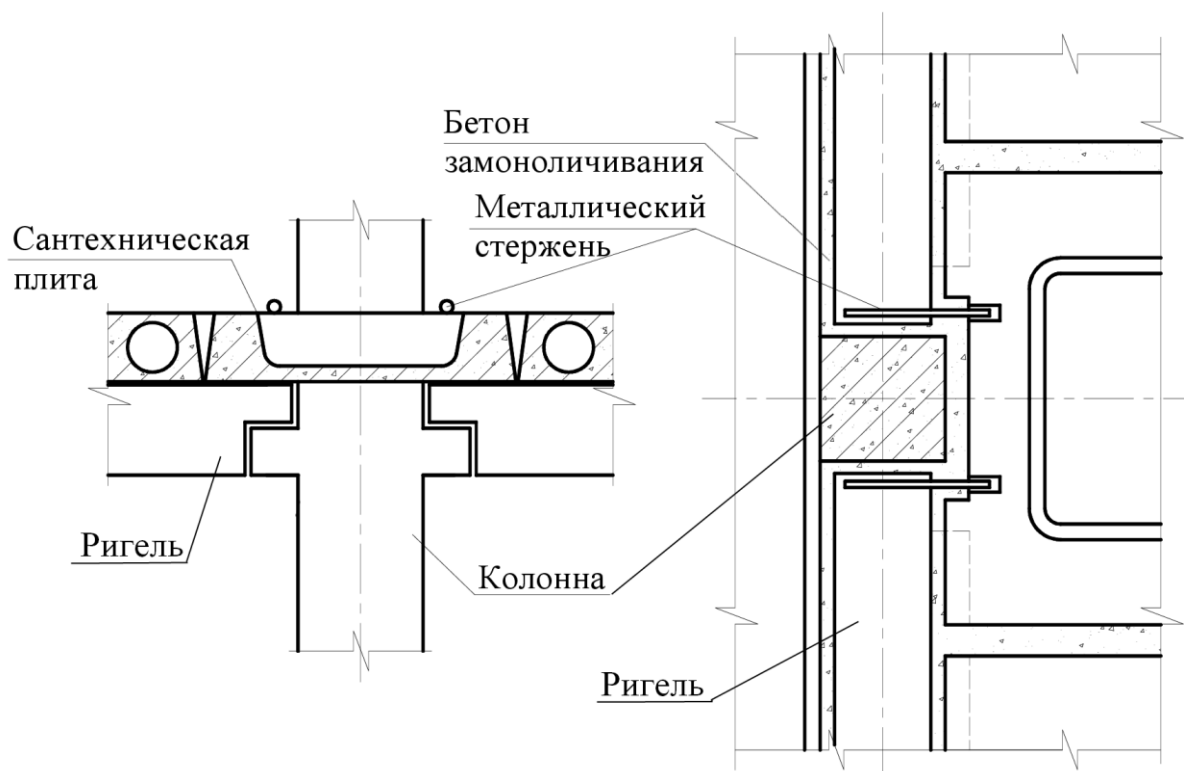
Схема опирания многопустотного перекрытия на ригель по серии 1.041.1-3 [4] с сантехнической межколонной плитой
